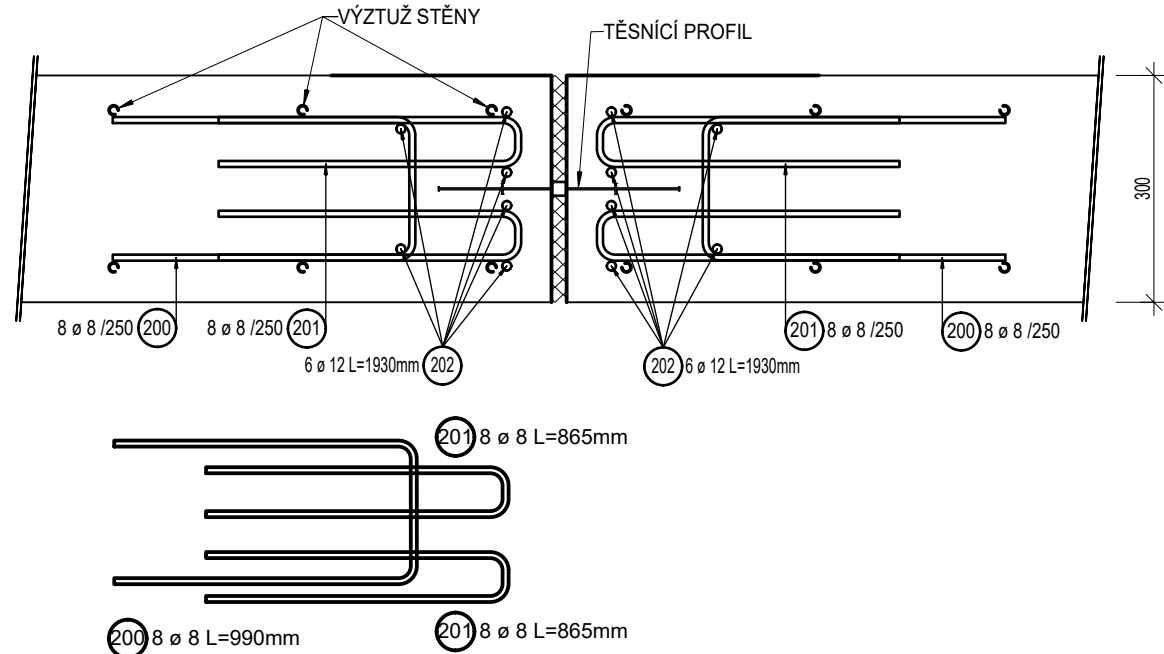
DETAIL VYZTUŽENÍ ŠIKMÝCH ROHŮ
